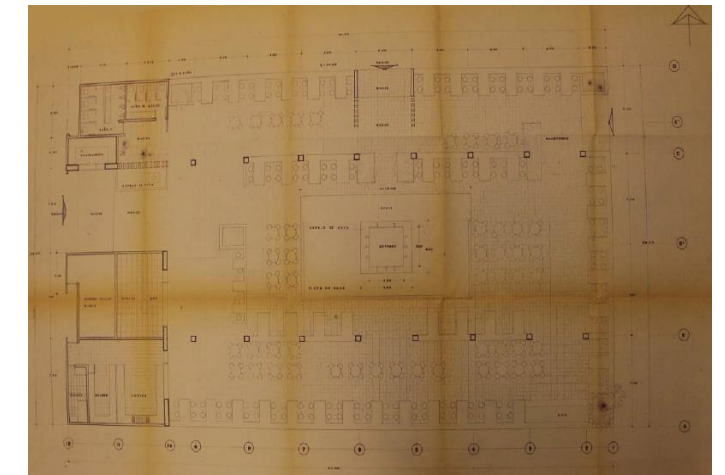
Planta arquitectónica de proyecto original (Patiño, 2017, p.58).
